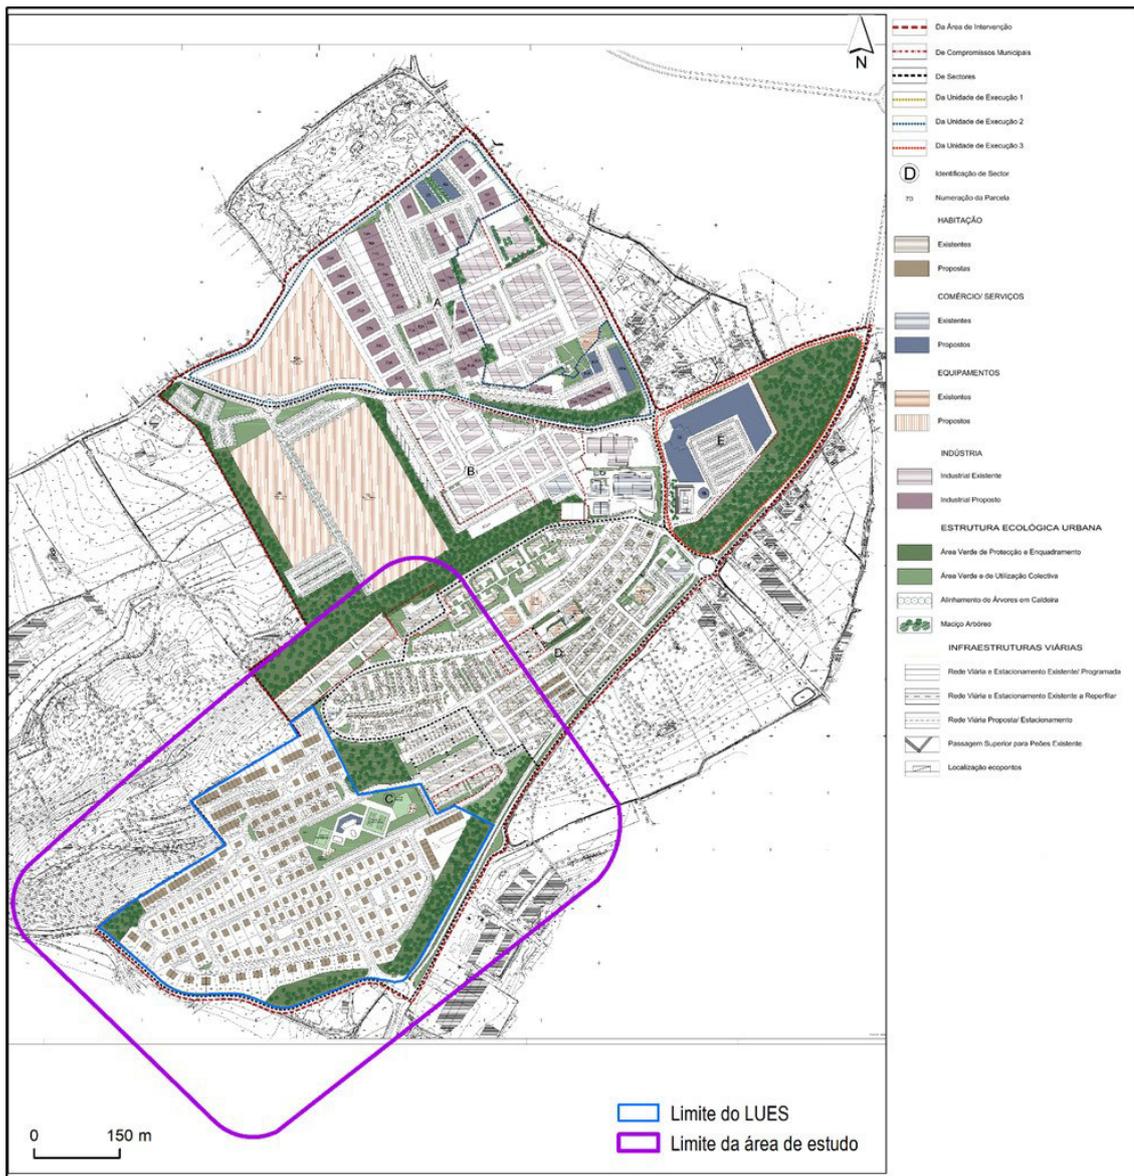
Enquadramento do LUES na Planta de Implantação do PPC
